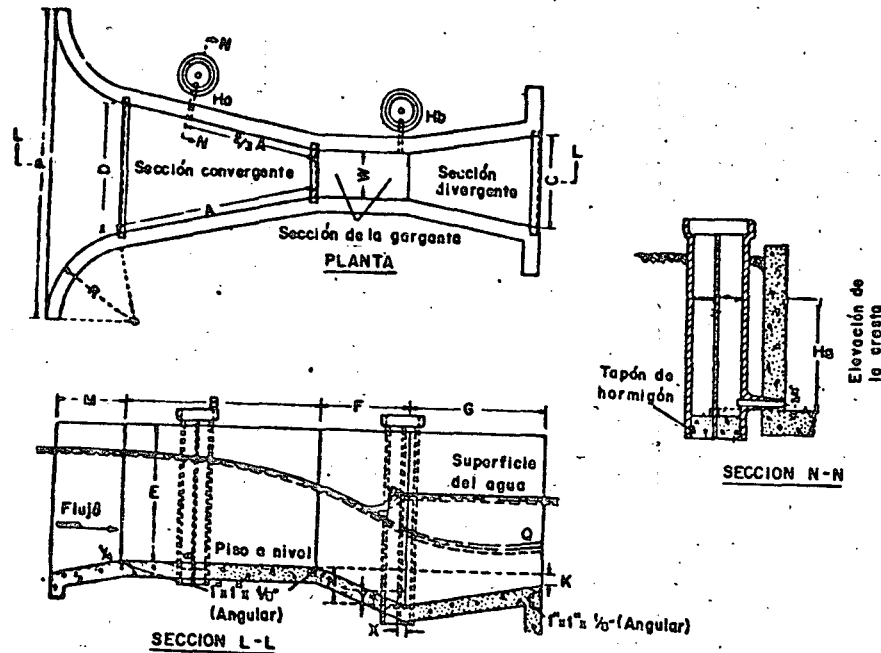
Fig. XIX - Planta, elevación y dimensiones de un canal Parshall
